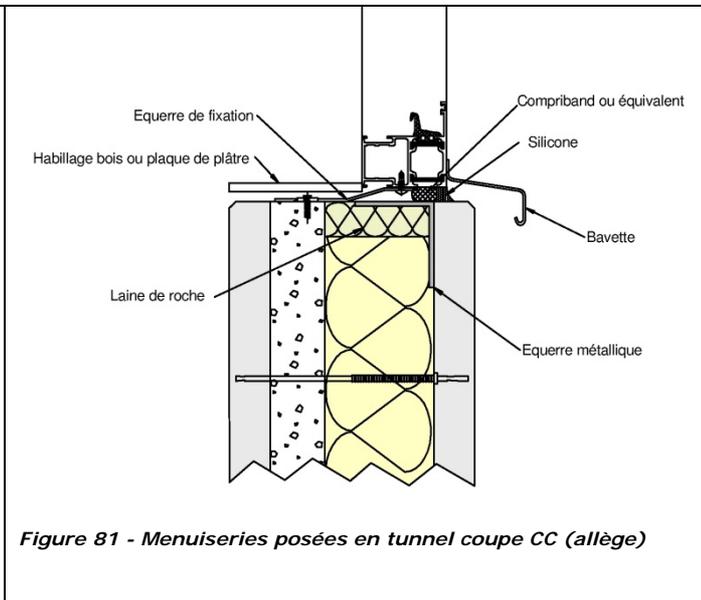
Menuiseries posées en tunnel coupe CC (alège)
